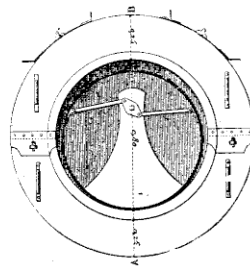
Service des eaux. Cintre métallique pour conduites en béton.
